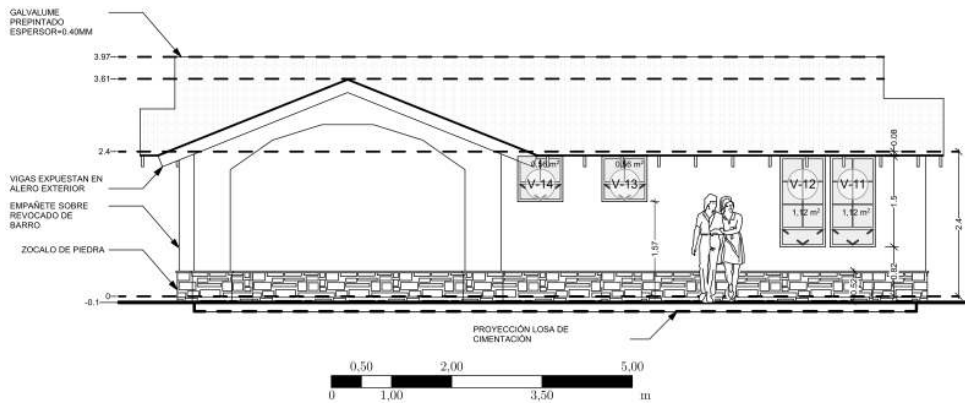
Elevación lateral derecha (Oeste) del proyecto para Sr. Gerardo Campoverde.
